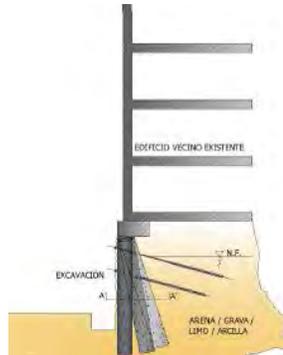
Calzaduras de estructuras vecinas a excavaciones y muros de contención
